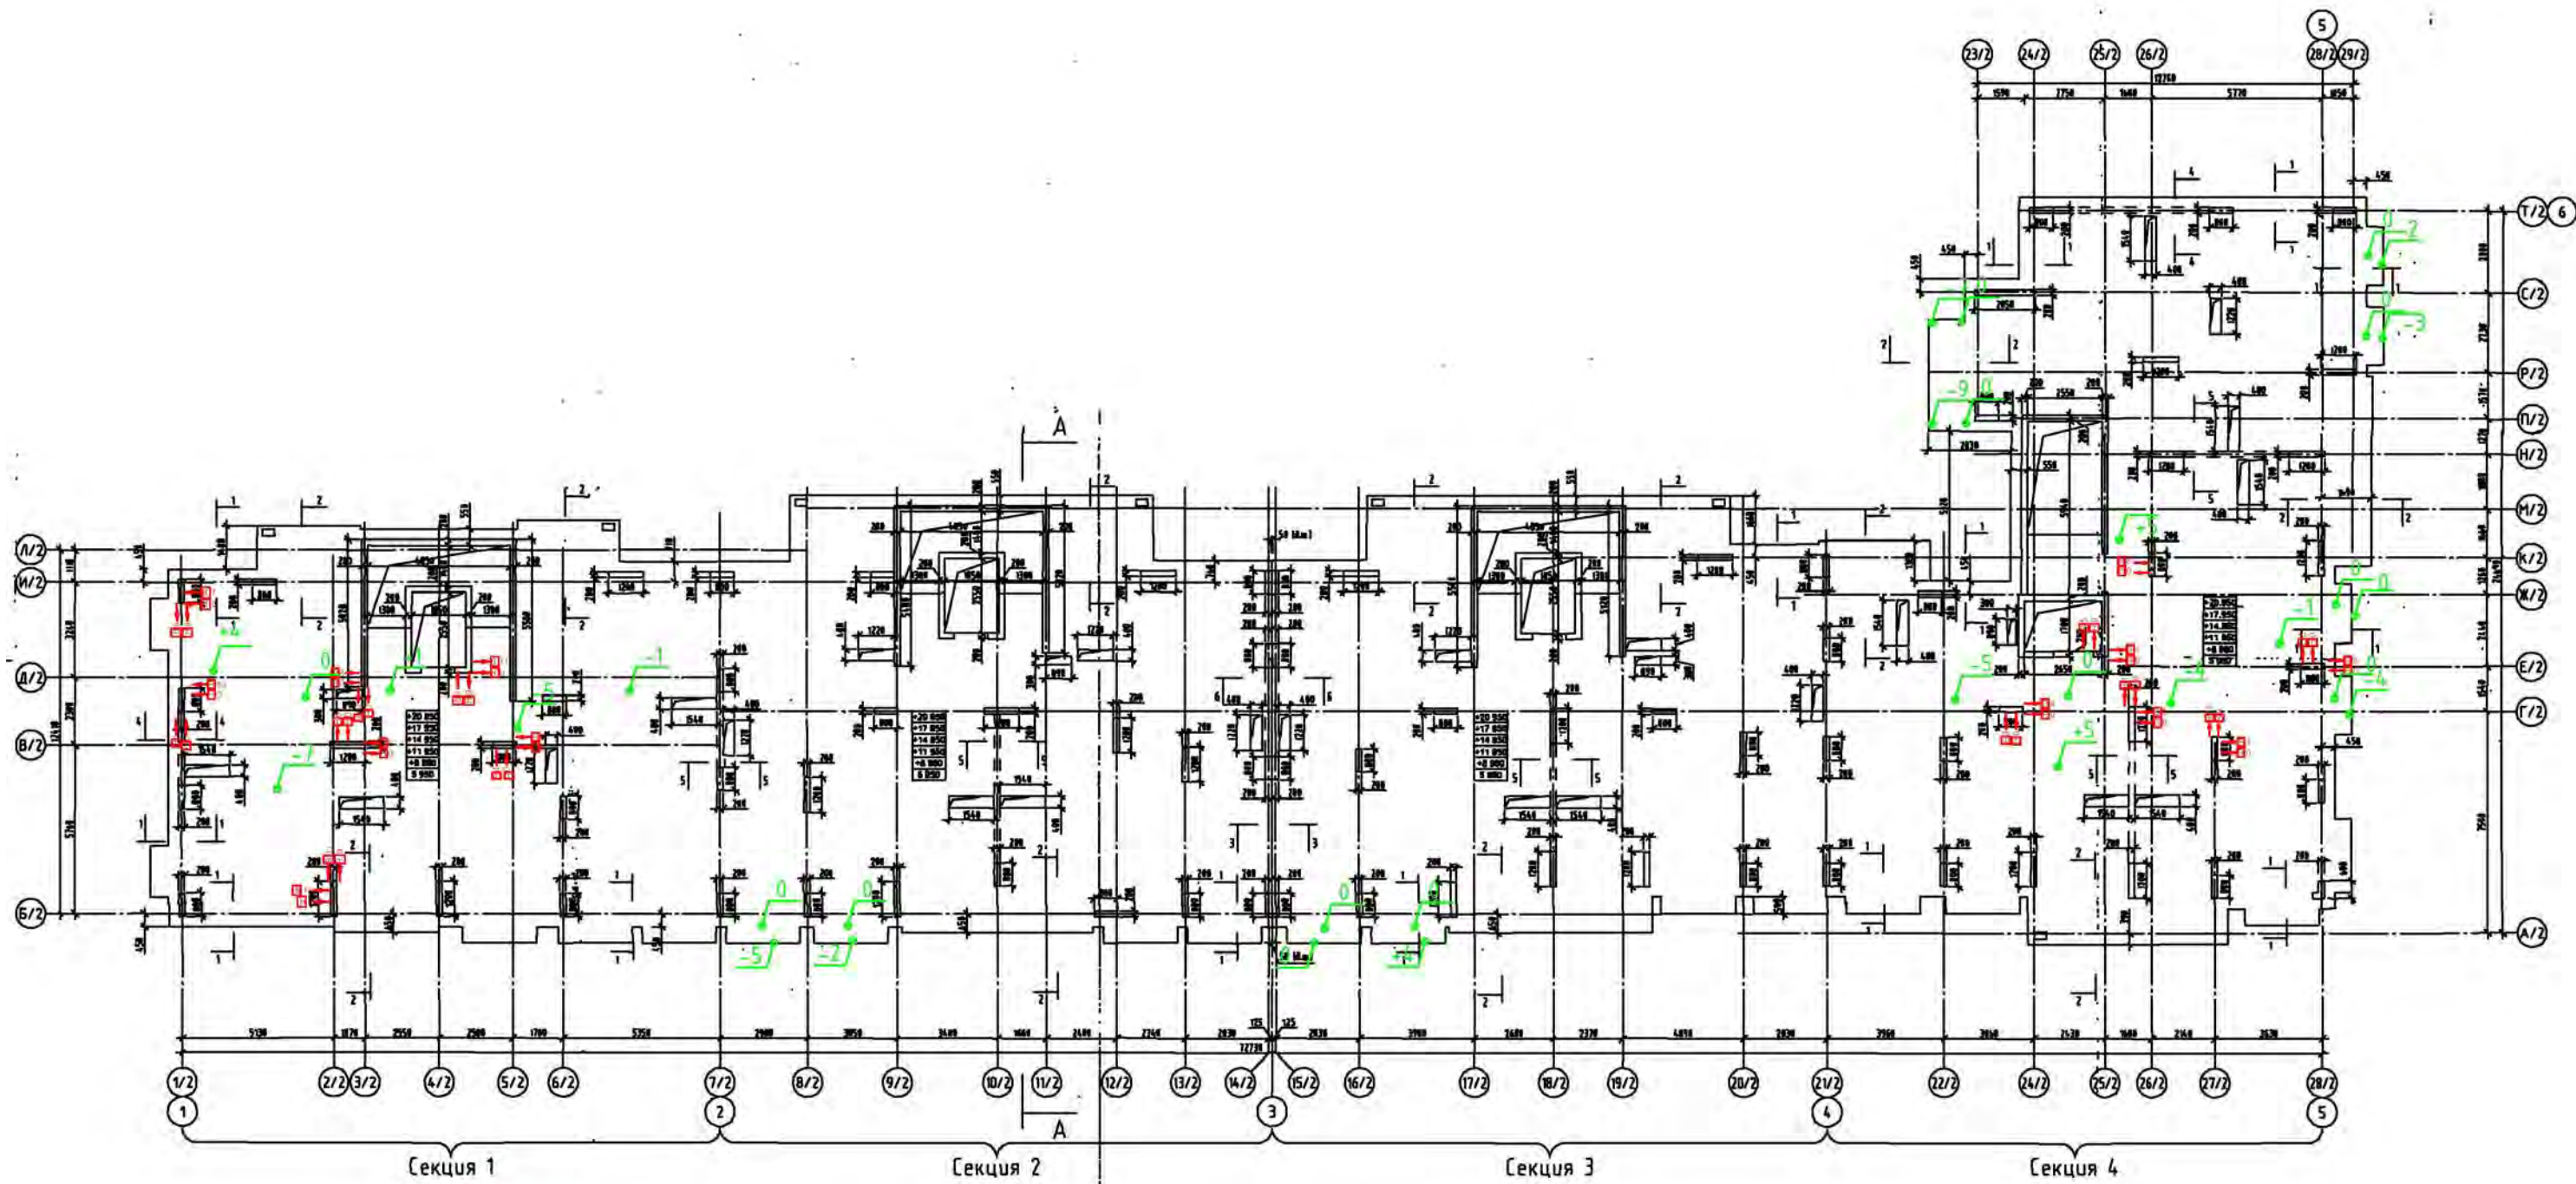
Отклонения от вертикали и горизонтали несущих монолитных железобетонных конструкций 1-го этажа
